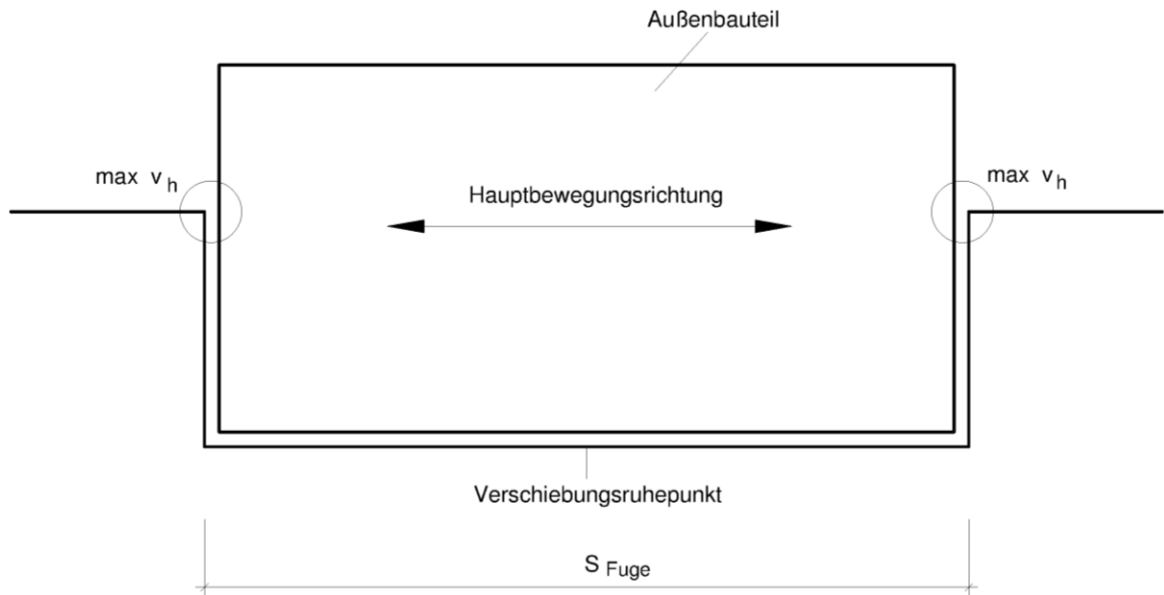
Einbausituation mit Lagerung an gegenüberliegenden Rändern
